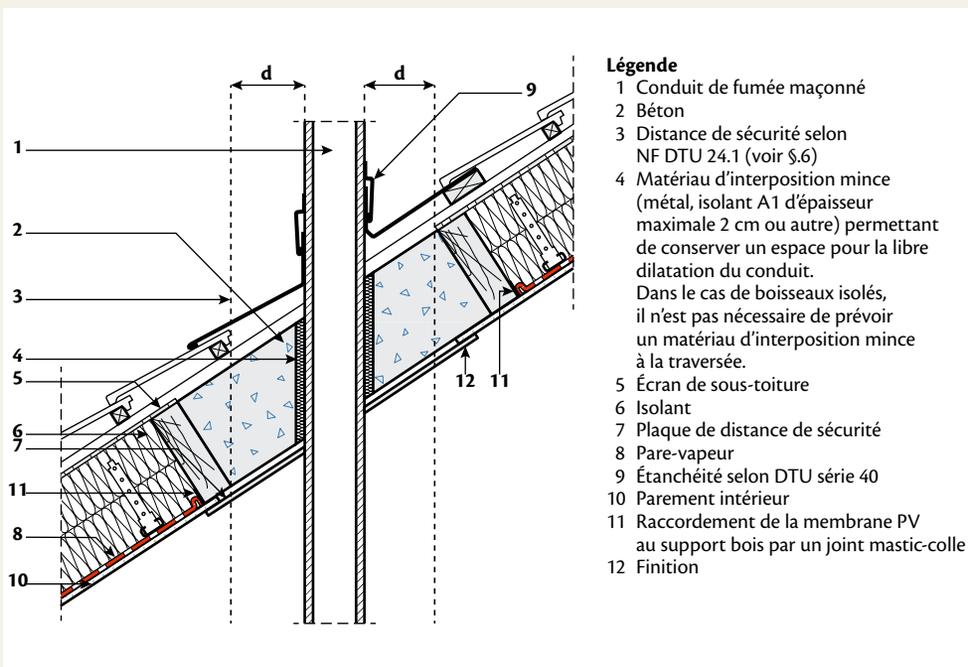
Jonction rampant – conduit de fumée maçonné
